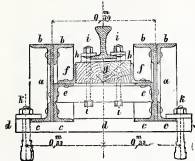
Eisenbahnbrücke mit zusammengefügten Zwillingsträgern.
